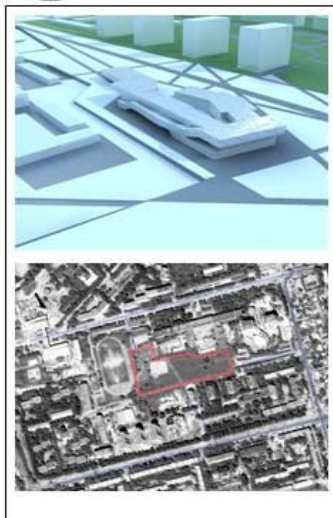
План посадки здания на рельеф и формирование формы здания школы
